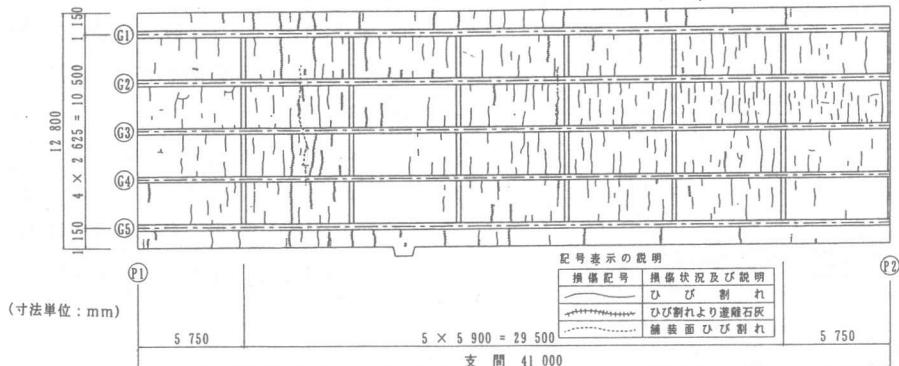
安谷屋橋の第2スパン部のコンクリートひび割れ損傷図
